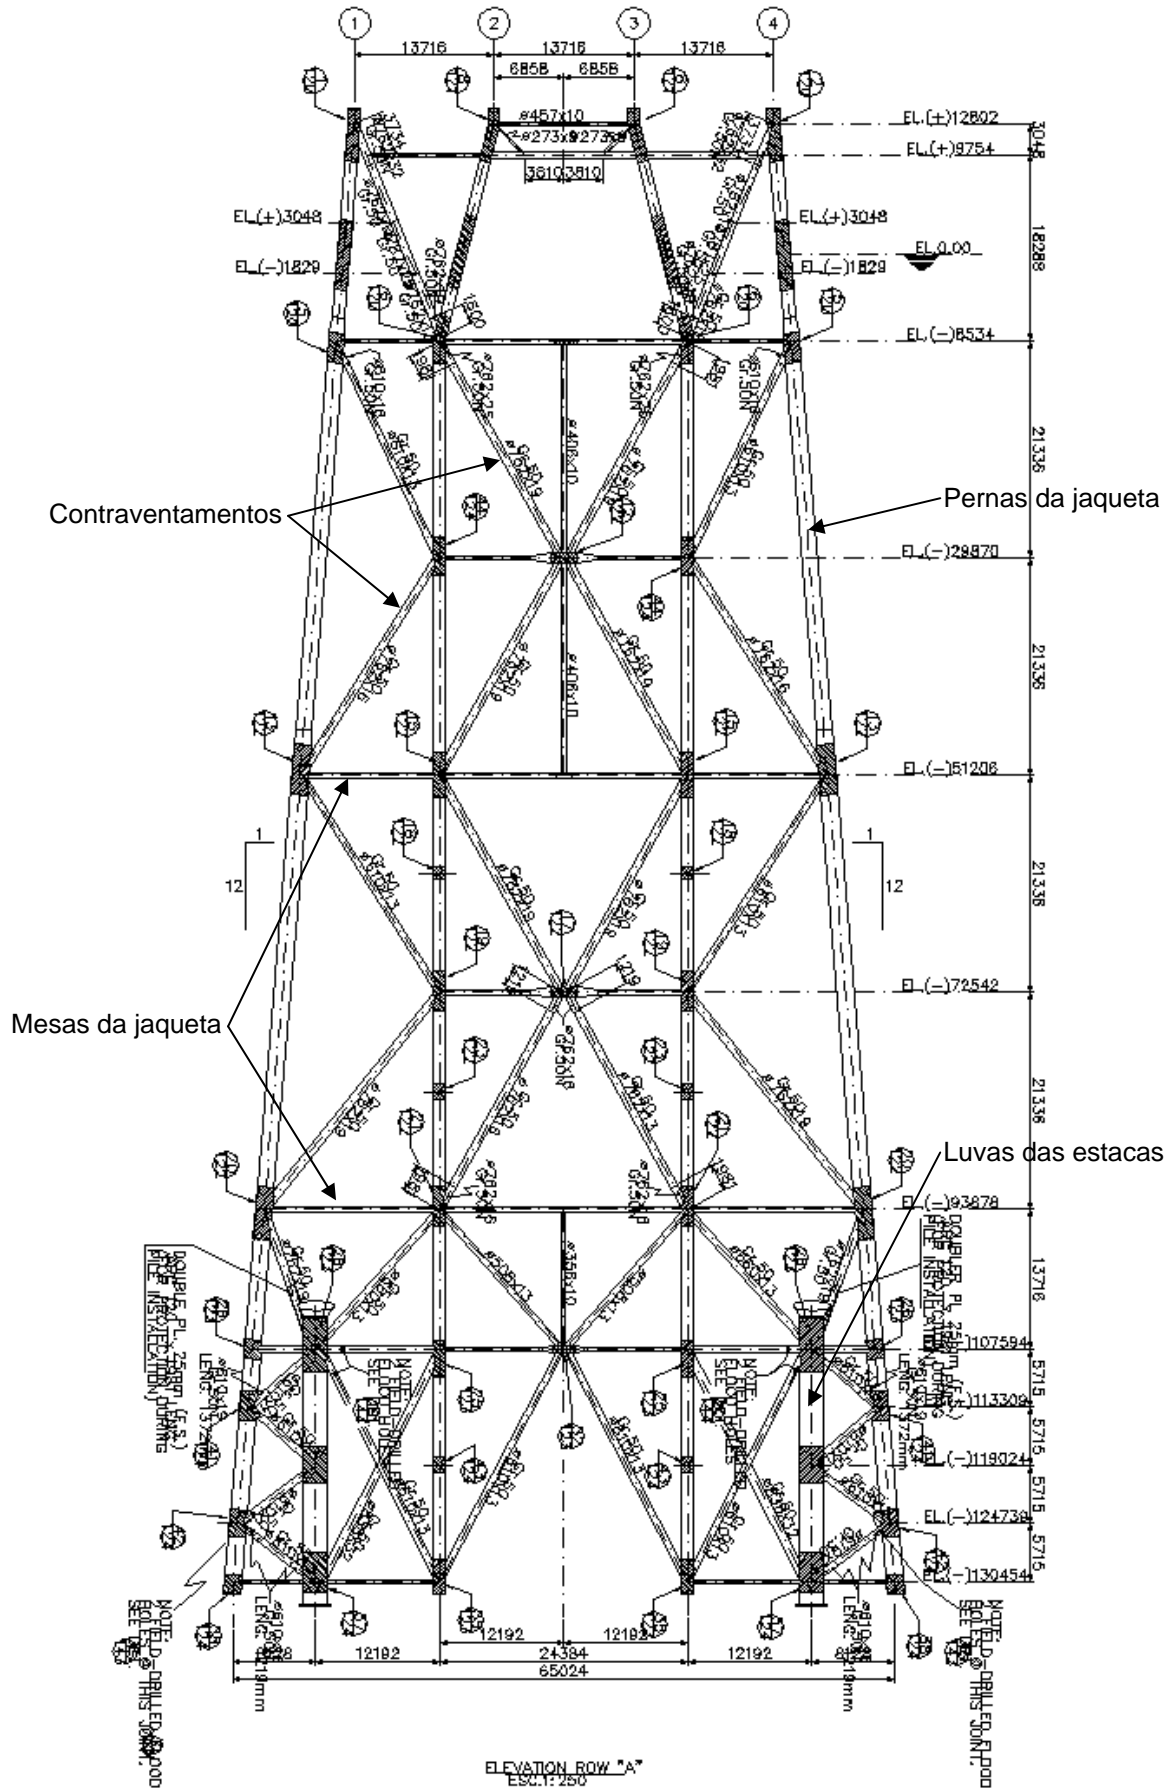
Jaqueta – Elevação do Eixo A (cotas em mm)
